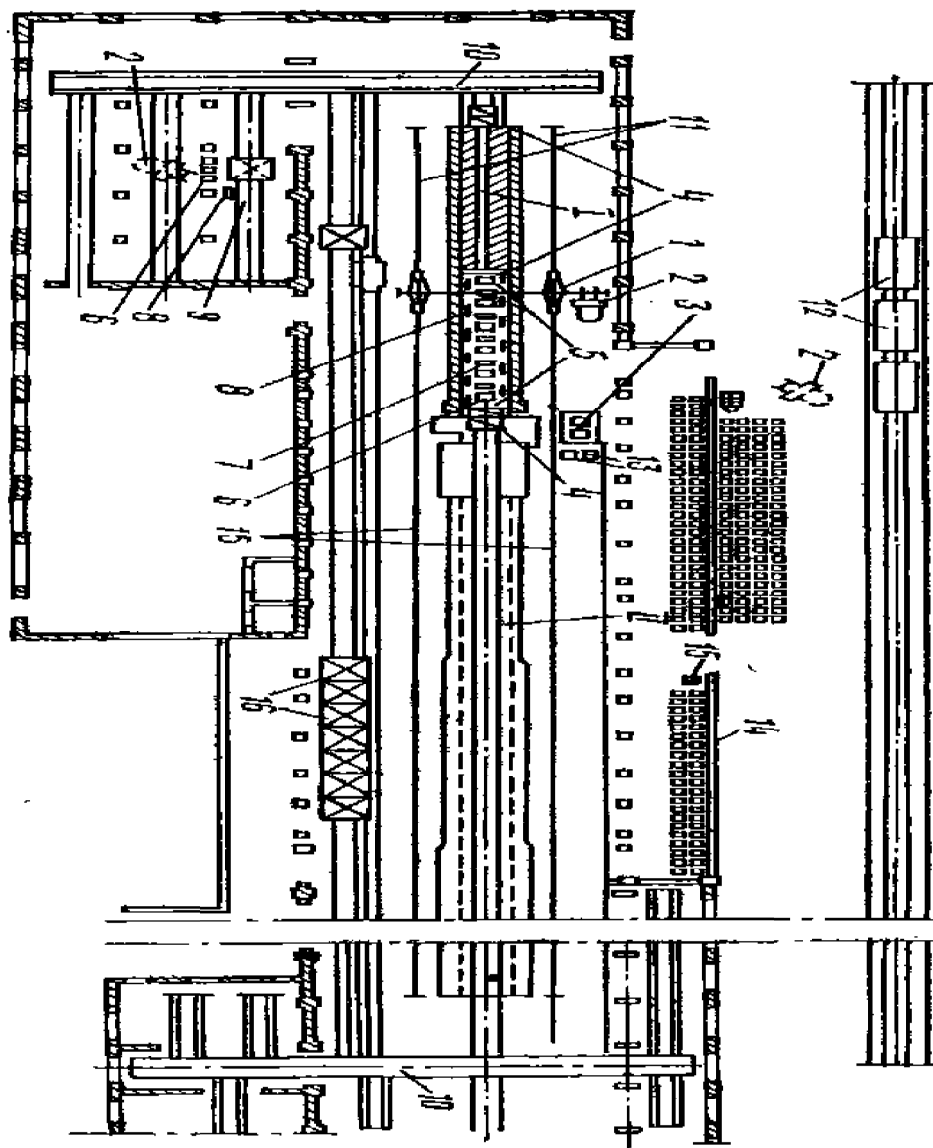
Стройгенплан организации работ по кладке туннельной печи: I –
